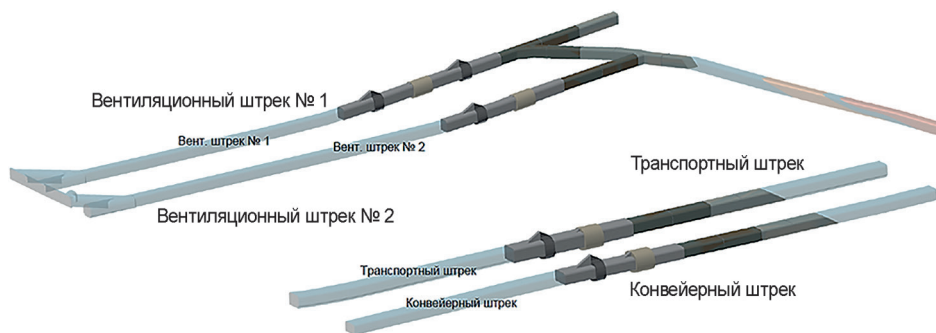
Схема расположения гидроизолирующих сооружений (выделены темным цветом) в выработках
